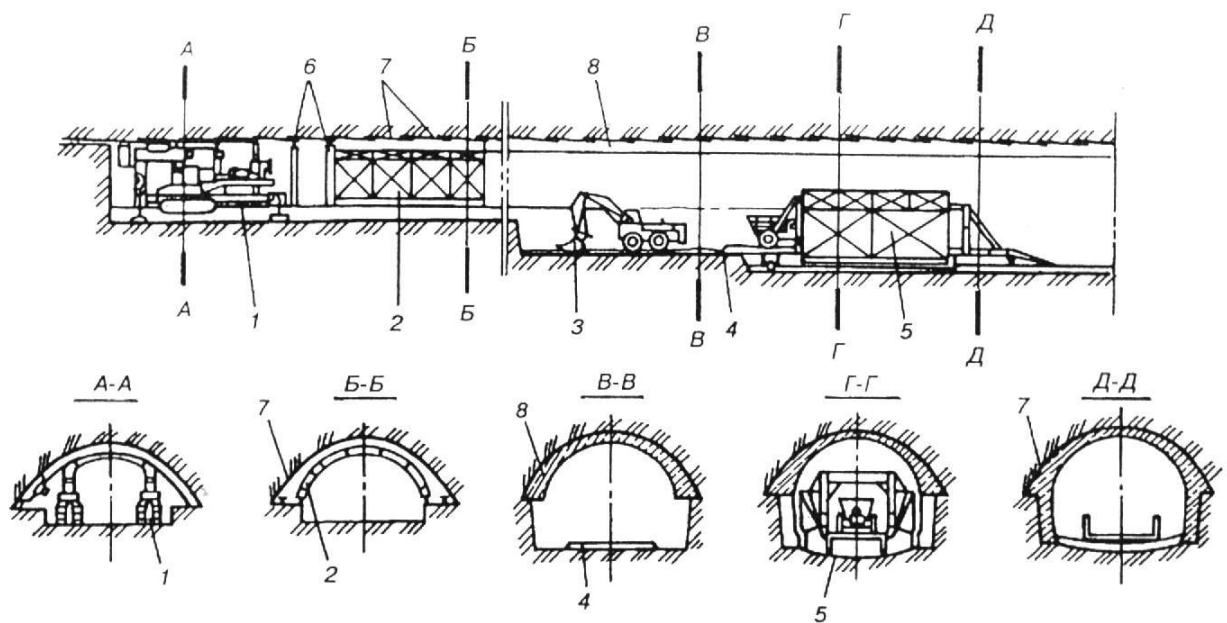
Технологическая схема проходки с ОБК методом нижнего уступа:
